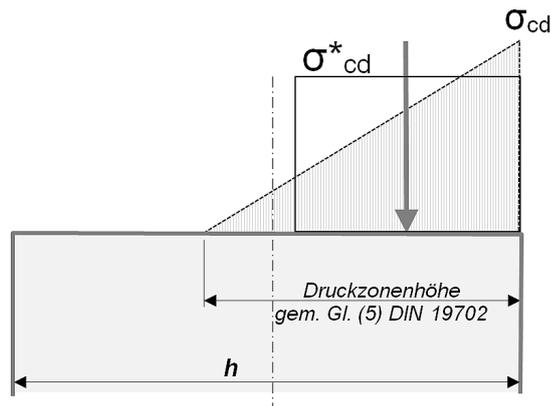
Rechnerische Spannungsverläufe im Bemessungsschnitt
